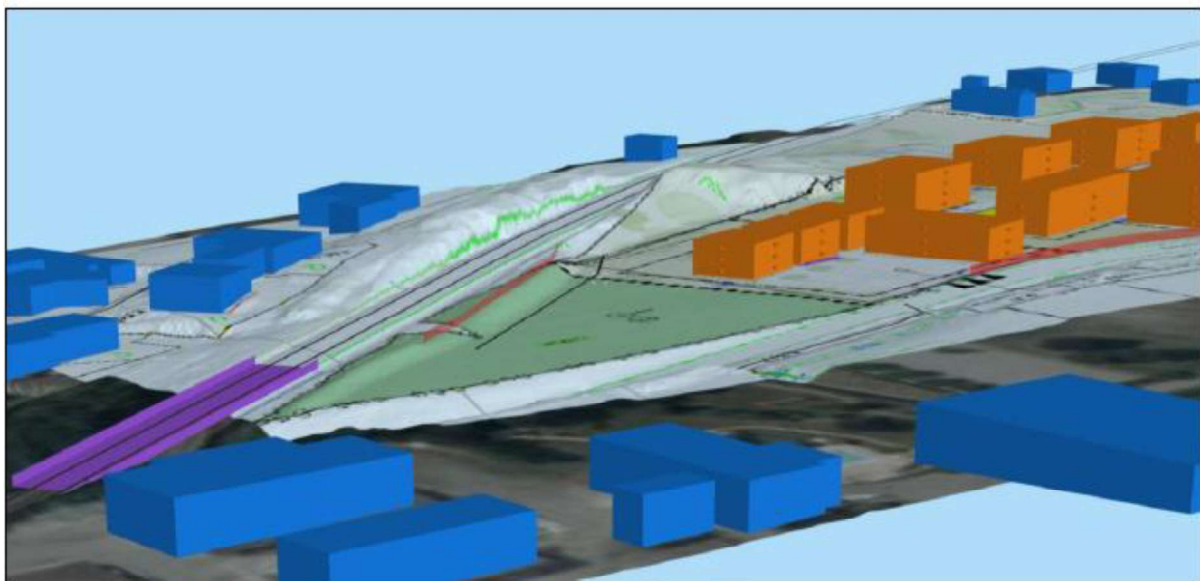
IMMI 3D-Modell Erhöhung Erdwall Bahntrasse Ansicht Nordost (Quelle: DI Künstner, Lärmbüro)
